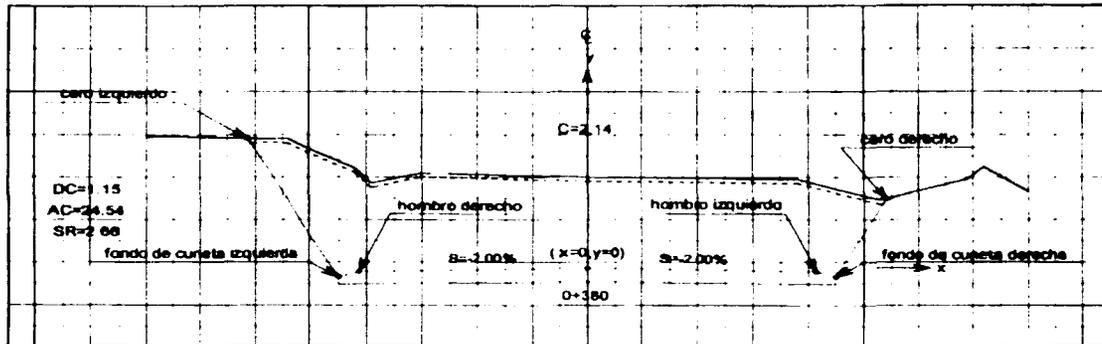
SECCIÓN TRANSVERSAL DE CONSTRUCCIÓN EN CORTE
